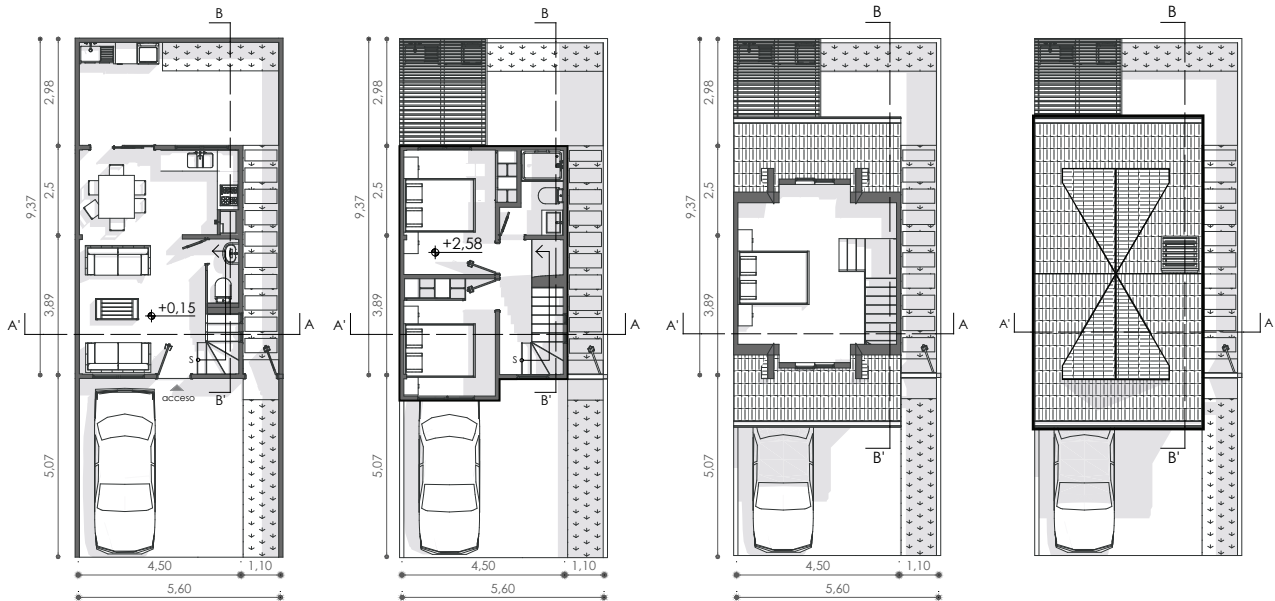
Plantas arquitectónicas remodeladas de vivienda seleccionada
